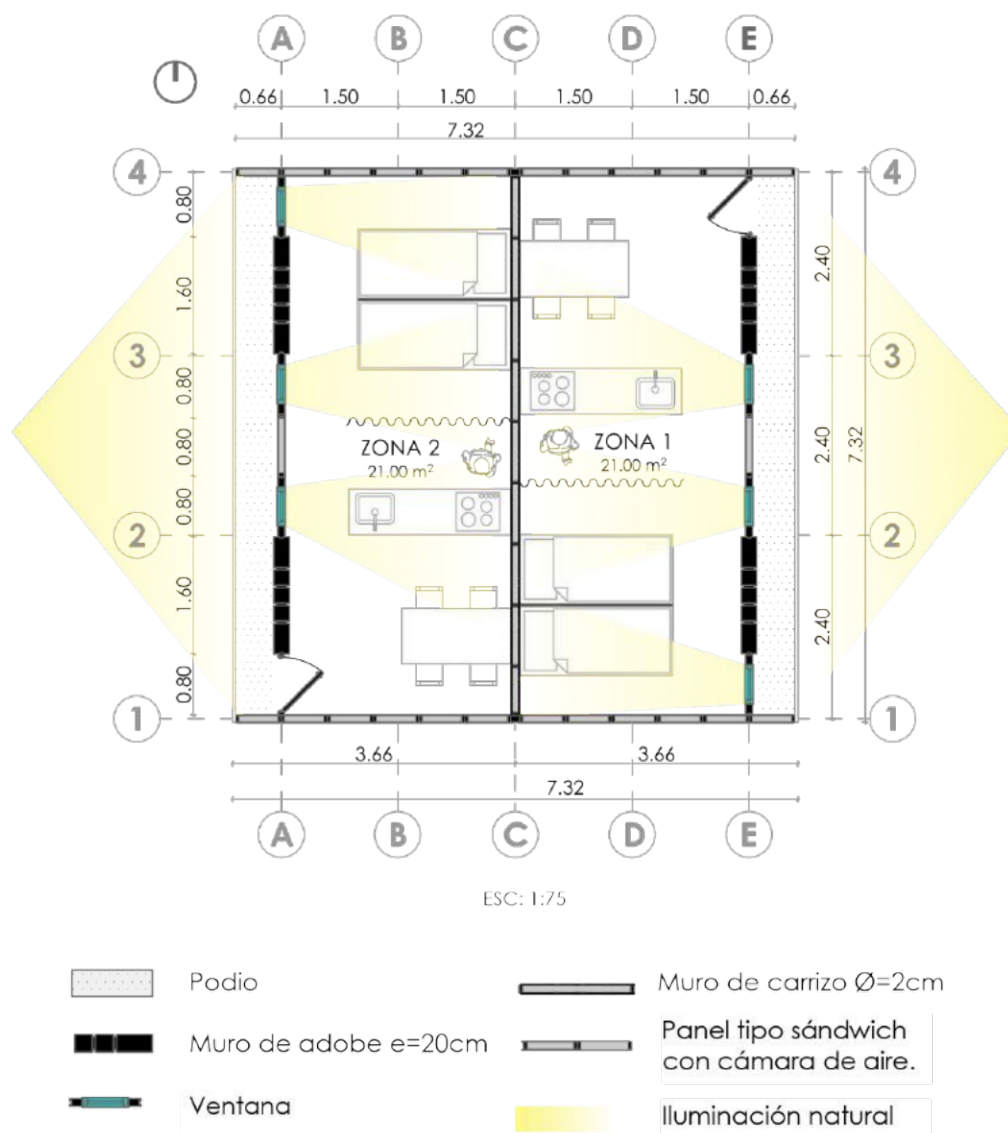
Iluminación interior de la propuesta de estudio mediante las fachadas este-oeste.
